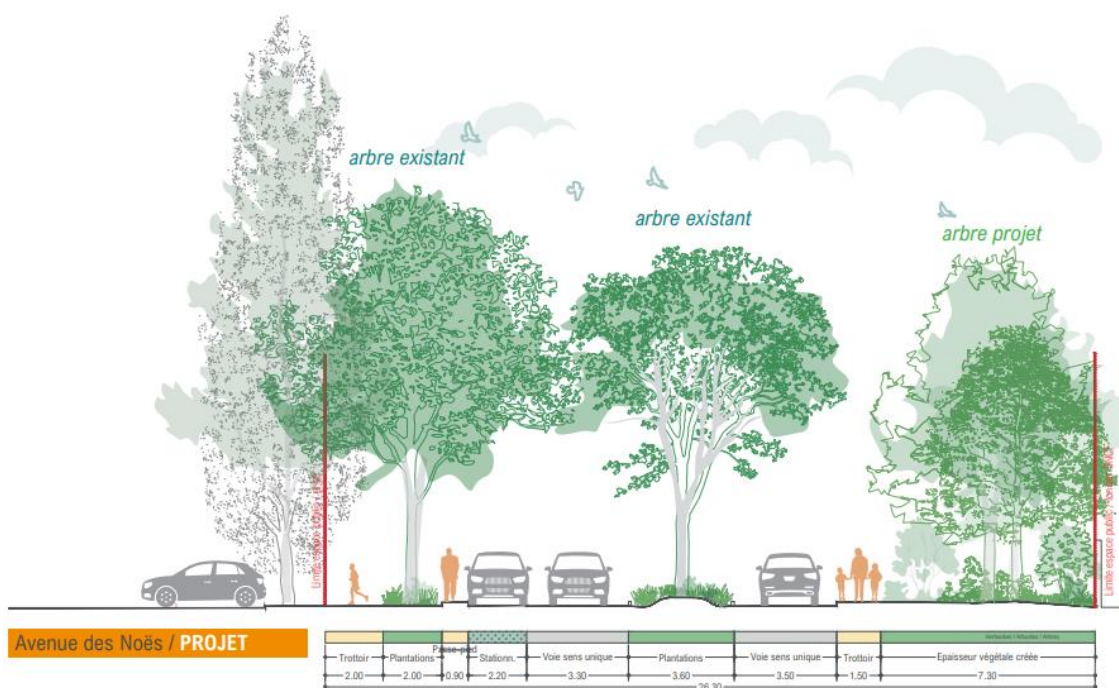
Coupe de principe au niveau de l'Avenue des Noës (La Fabrique Urbaine, 06/2024)
